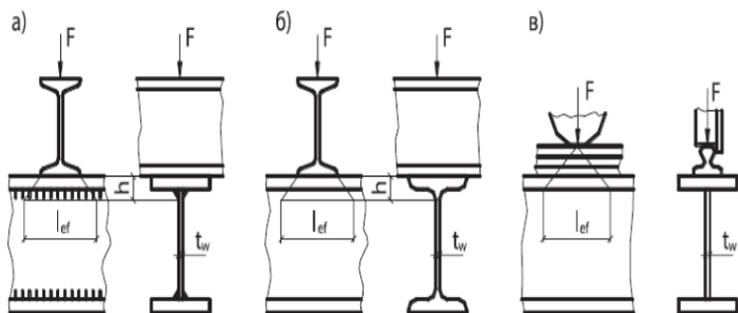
Схемы распределения сосредоточенной нагрузки на стенку балки (а - сварная балка; б - прокатная балка; в – сварная или прокатная балка при нагрузке от колеса крана).
